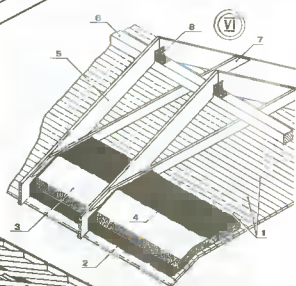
Монтажная схема несущих конструкций кровли: 1 — подшив потолка чердака; 2, 4 — пергамин; 3 — утеплитель; 5 — стропило; 6 — конышковый брус; 7 — распорная доска; 8 — Г-образная стальная пластина для крепления стропил.
